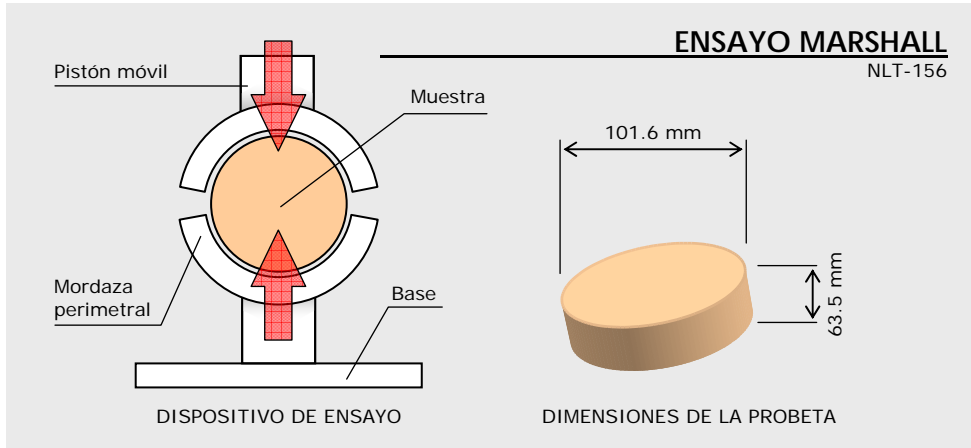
Ensayo Marshall para la dosificación de MBC (NLT-159)
